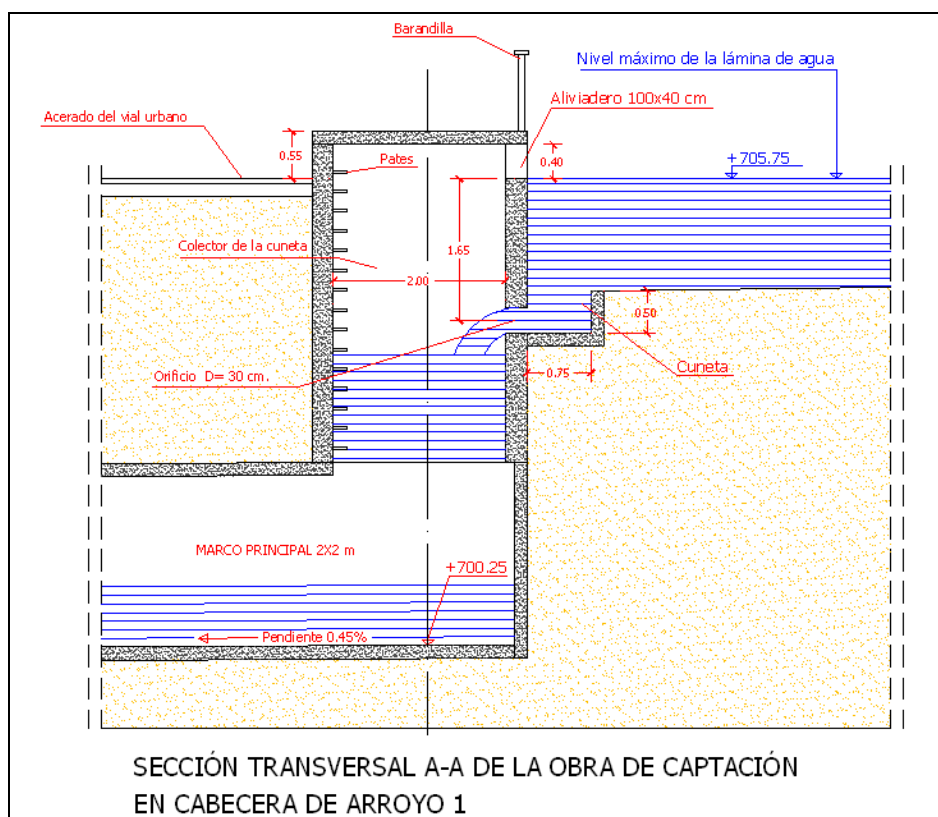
Sección transversal en la obra de captación en cabecera de arroyo 1
